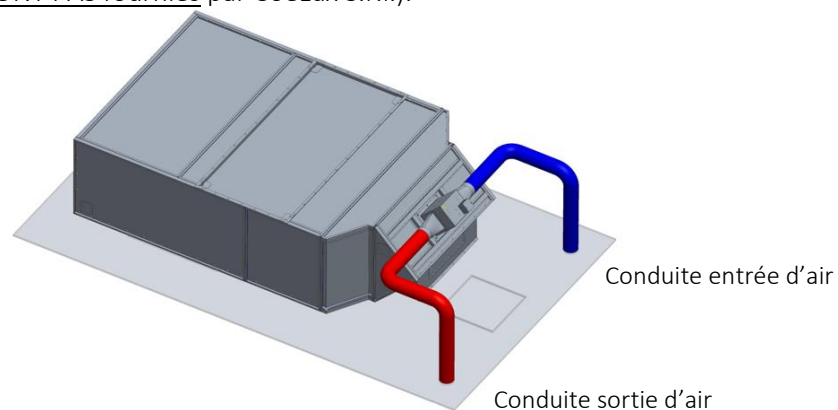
Schéma de branchement du système de ventilation : vue du haut.
